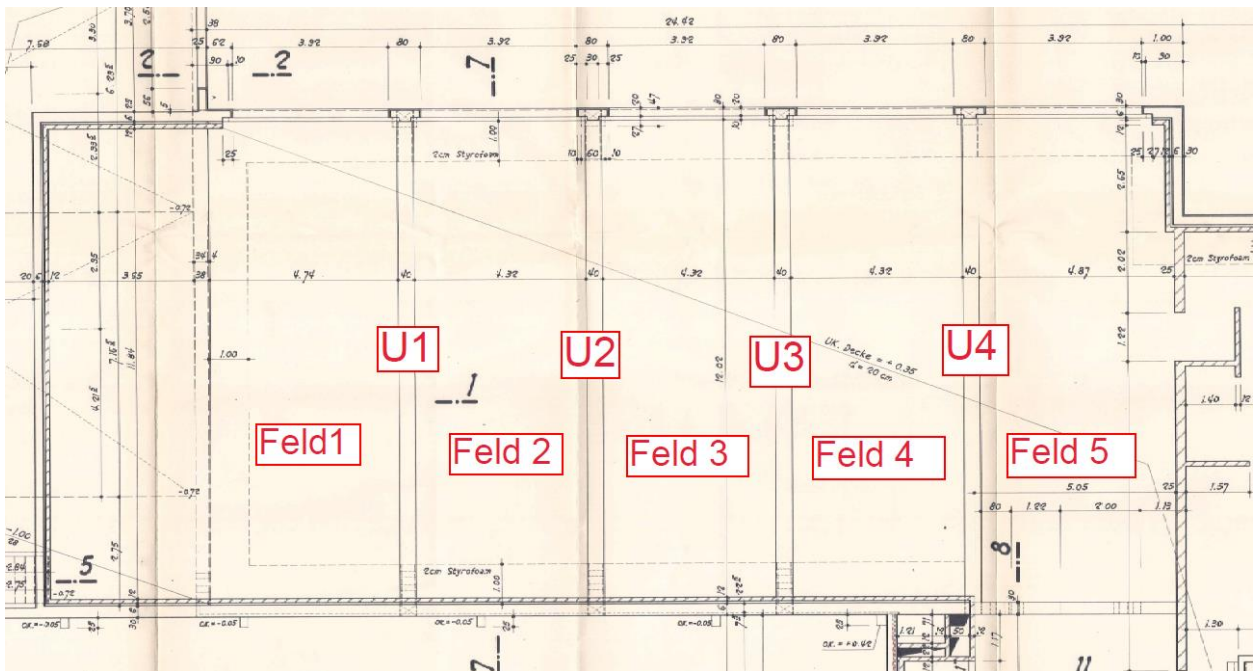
Grundriss Decke über Hallenbad
